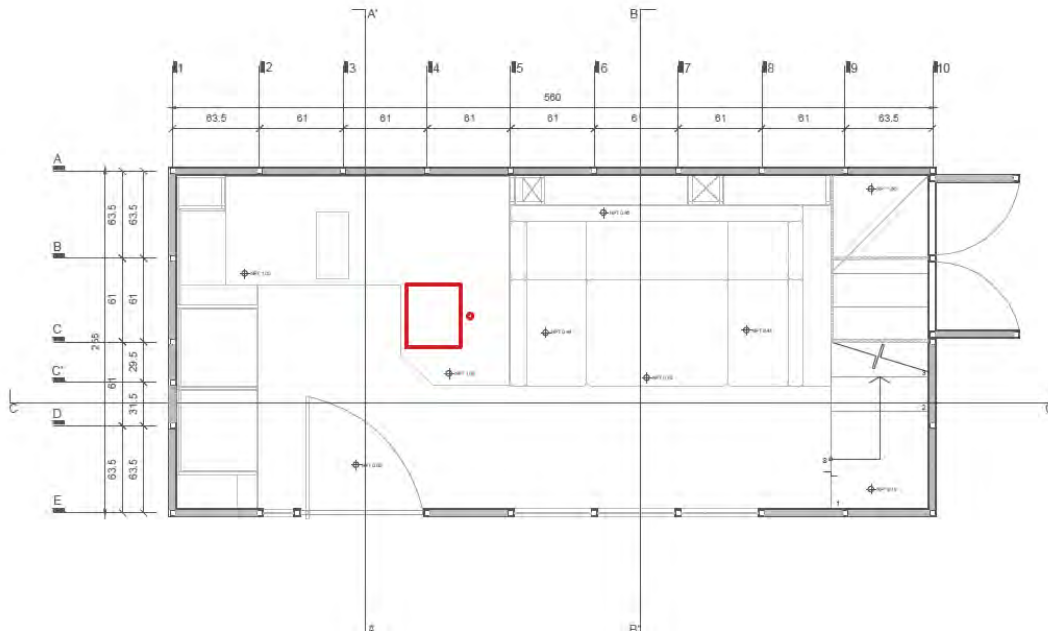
Planta, planta baja. Muebles que generan aguas negras.
